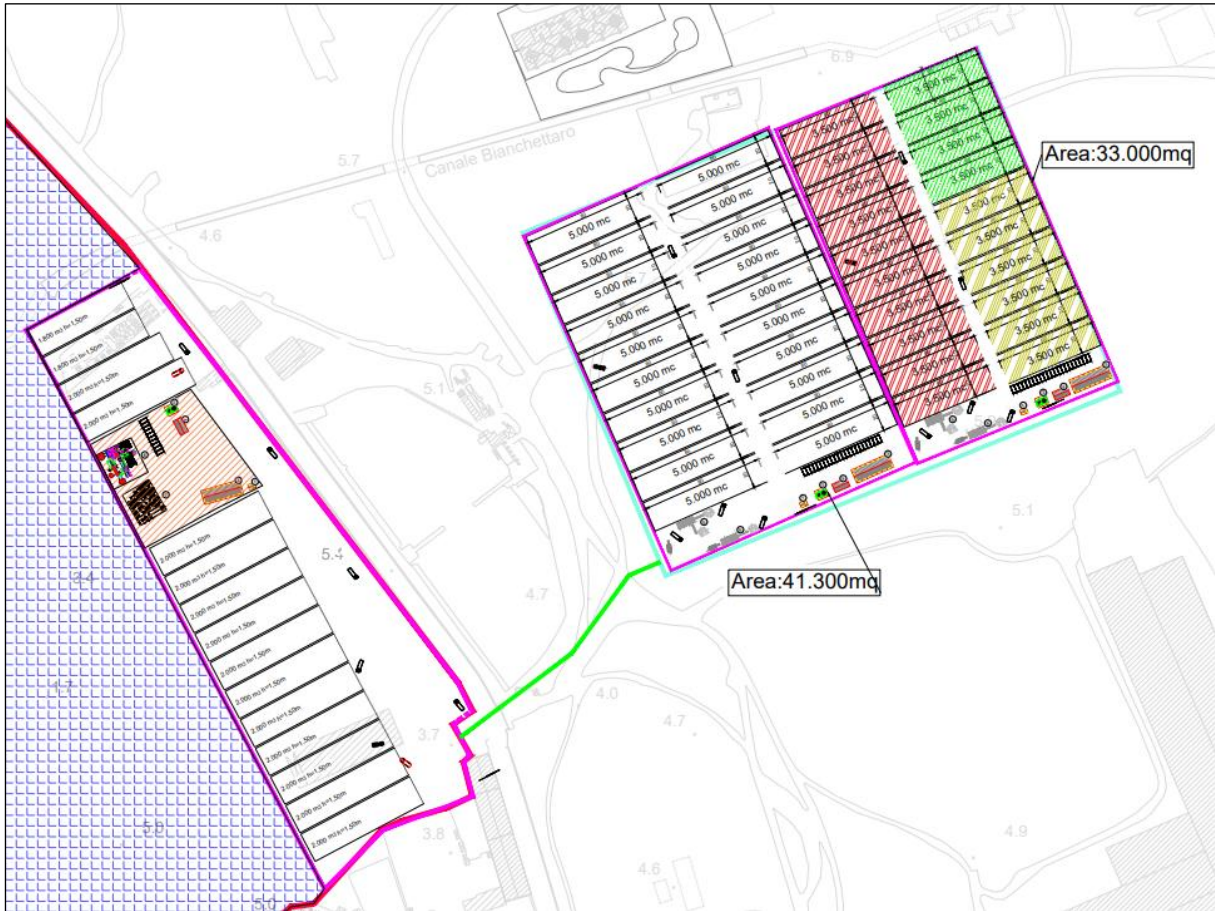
Dettaglio planimetrico delle aree di deposito terreni con indicazione delle aree baie di carico, piazzali, strade e aree impianti
